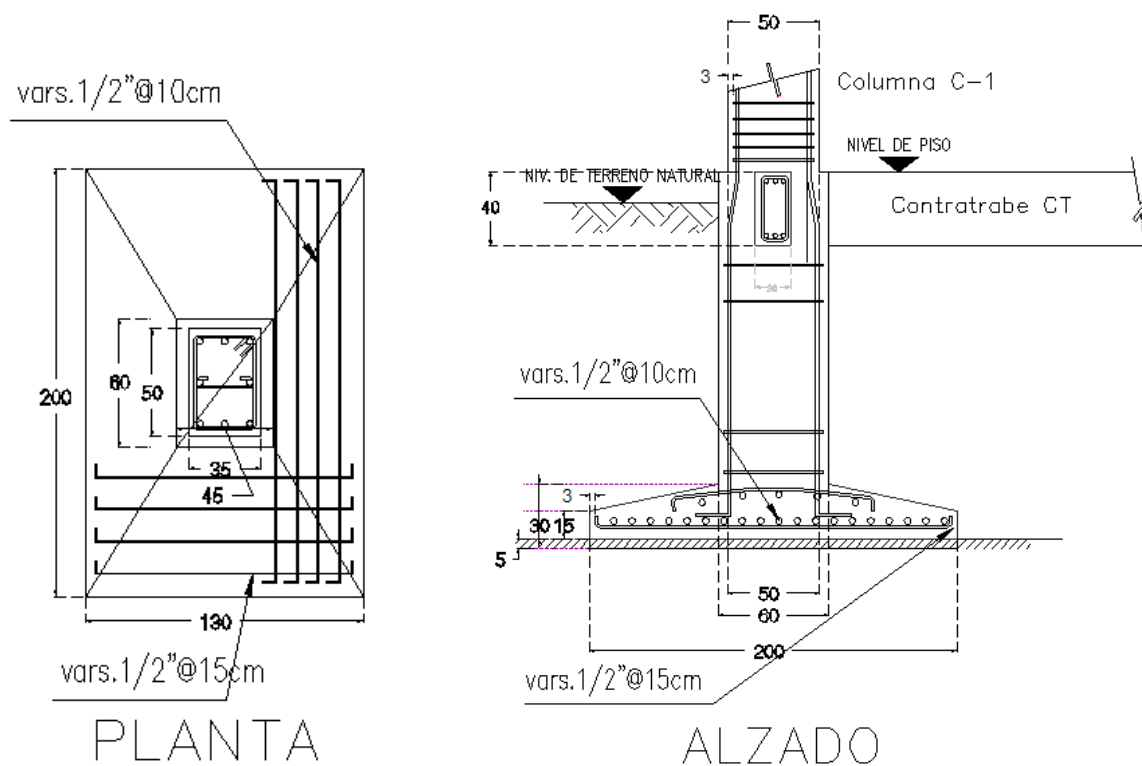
(Planta y alzado de la zapata Z2 actual).
